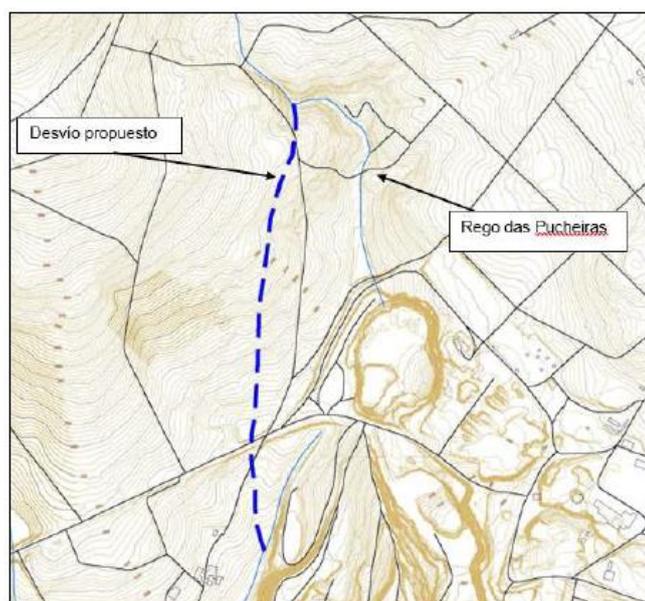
Trazado en planta del desvío propuesto del Rego das Pucheiras
